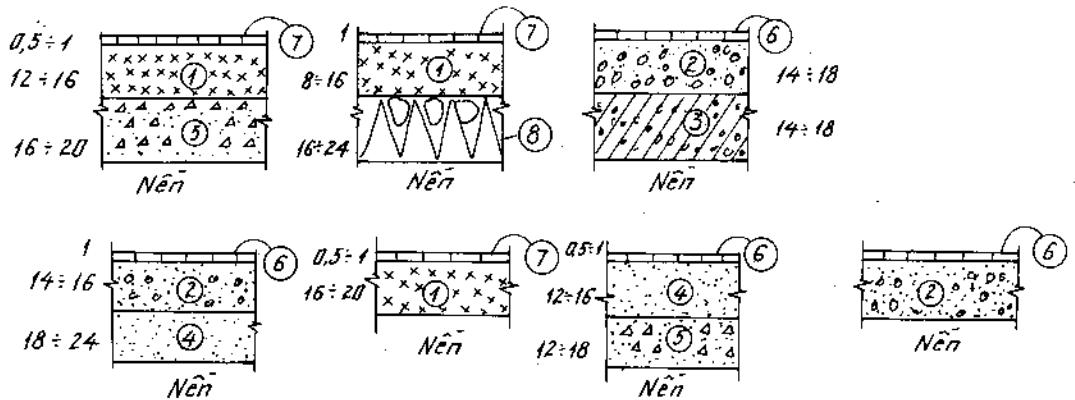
11. Kết cấu áo đường mềm cấp cao.
